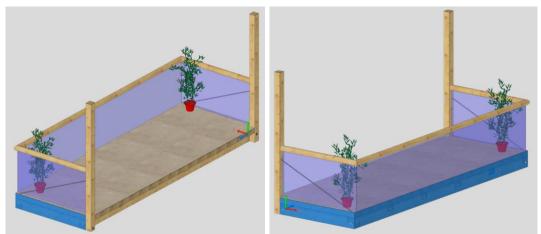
Alternativa 1 – balcón agregando pilares de madera.
